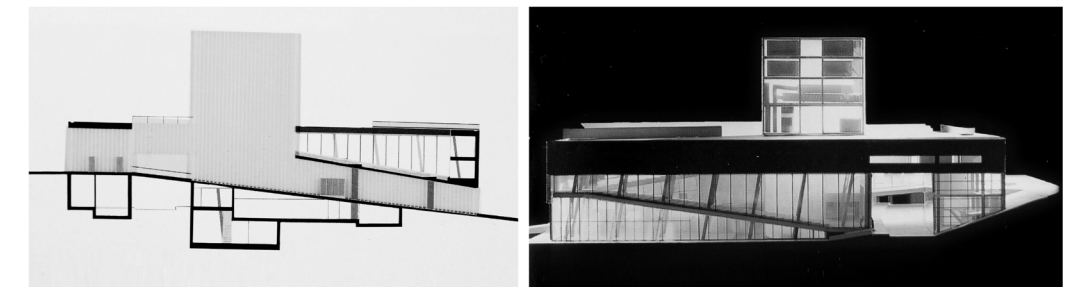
| Sección Norte-Sur y Maqueta. Kunsthall, Rotterdam.
